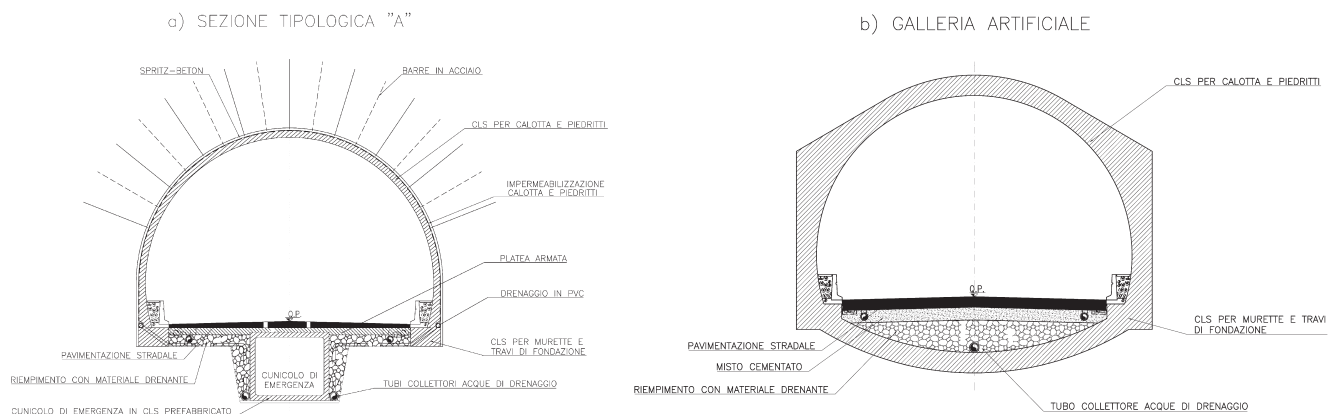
a) Galleria naturale, sezione di rivestimento corrente tipo A; b) Galleria artificiale, sezione di rivestimento. *Natural tunnel, lining system "corrente tipo A"; b) Artificial tunnel, lining system.
